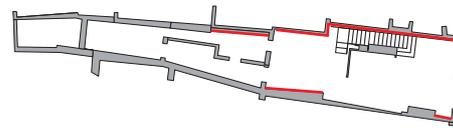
Coupe longitudinale du bâtiment du n° 15 place Planchat et du n°17 place Planchat. (d'après le fonds de plan informatisé de l'Atelier Christian Gimmonet).
